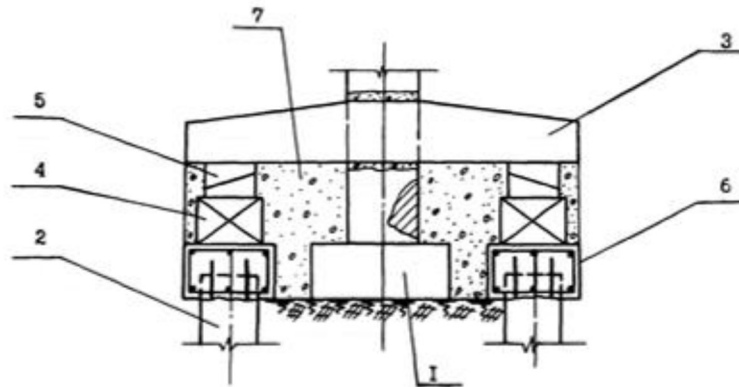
Підсилення фундаменту пально-каркасною конструкцією: 1 – підсилений фундамент; 2 – збірна залізобетонна палля; 3 – ригель; 4 – підкладка; 5 – сталеві клини; 6 – монолітна в'язка паль; 7 – бетонна заливка
